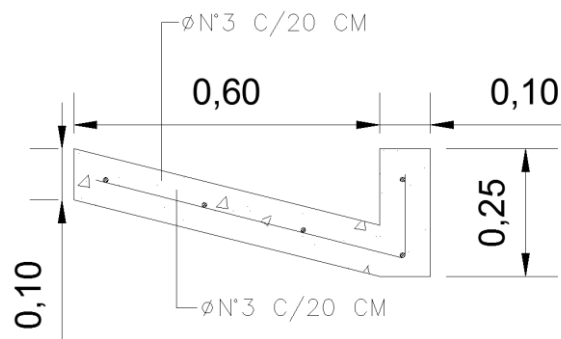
Acero de refuerzo para cunetas (tramo 1)
